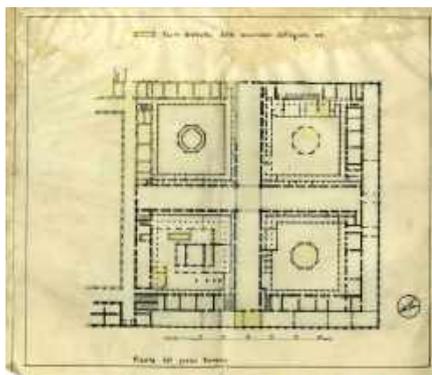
Cortili filaretiani, pianta piano terreno, stato di fatto prima dei lavori di restauro (giallo-parte distrutta dalle incursioni del 1943); tavola su lucido
